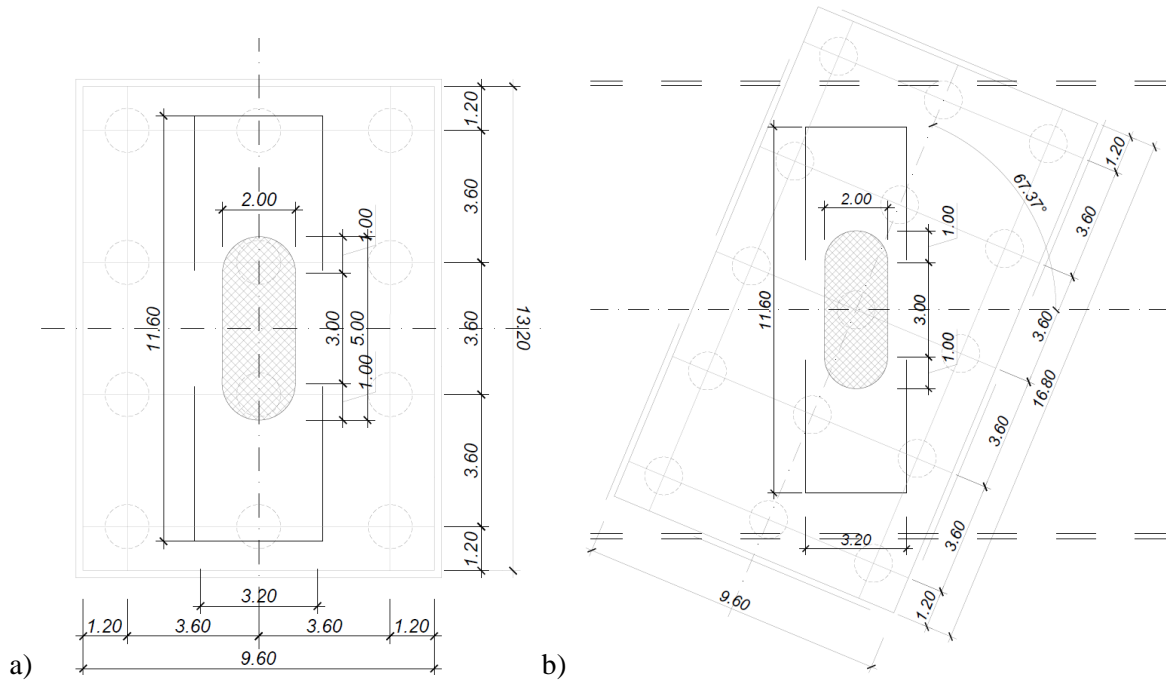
Vista in pianta pile- a) sezione di spiccato pile 1-4; b) sezione di spiccato pile 2-3
